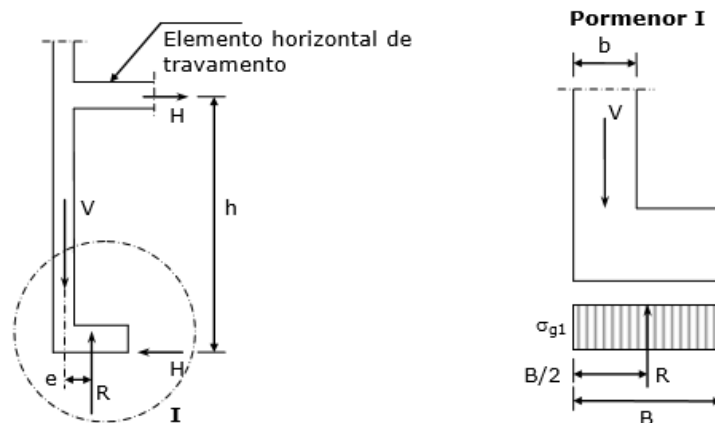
Sapata excêntrica com elemento horizontal de travamento. (Félix, 2014)
